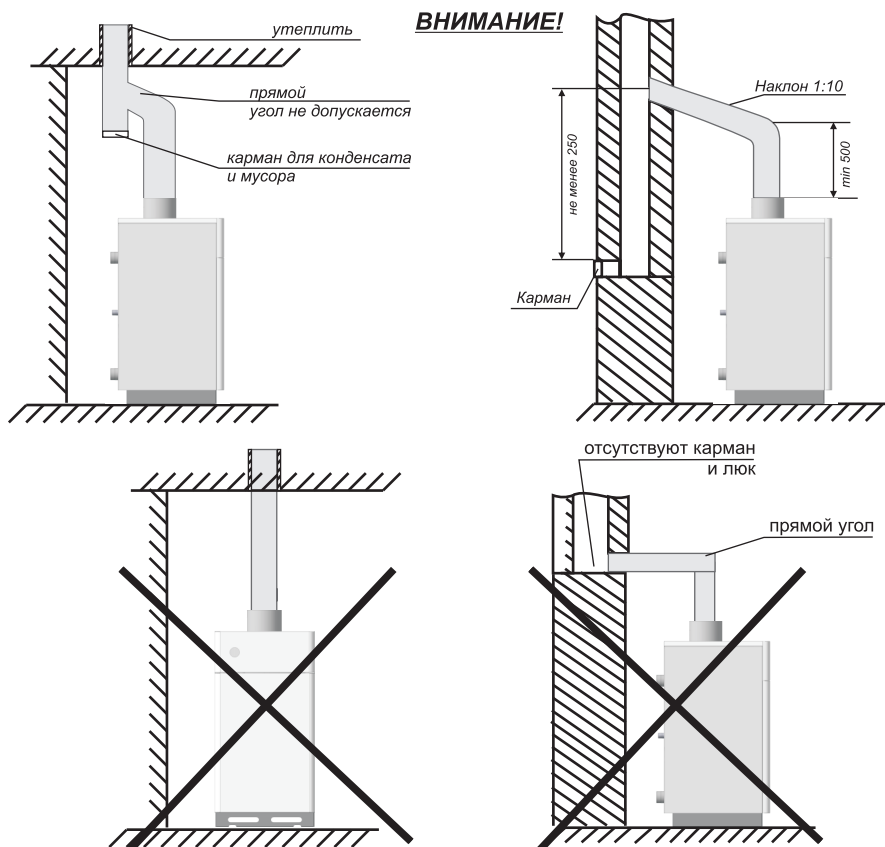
Схема подключения к дымовому каналу и план установки котла
